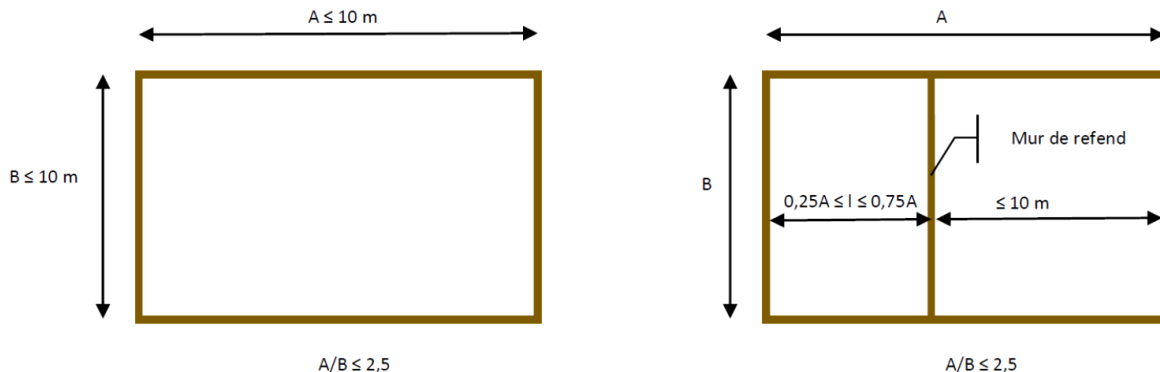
Restrictions dimensionnelles du bâtiment (Vue en plan du bâtiment)
